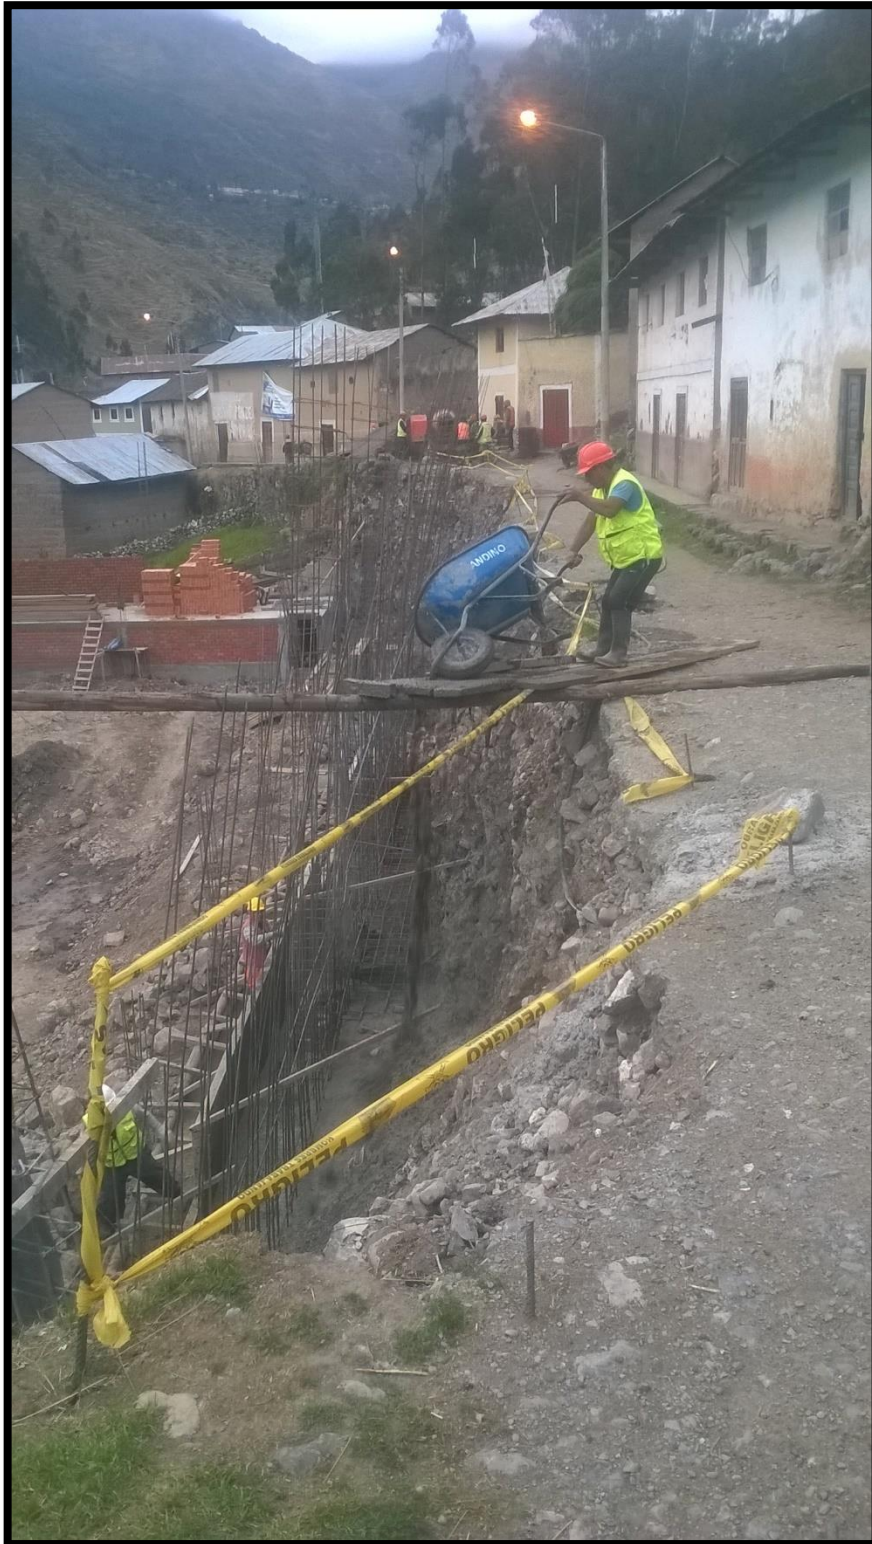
HABILITADO DEL ACERO DE REFUERZO DE LA VIGA
